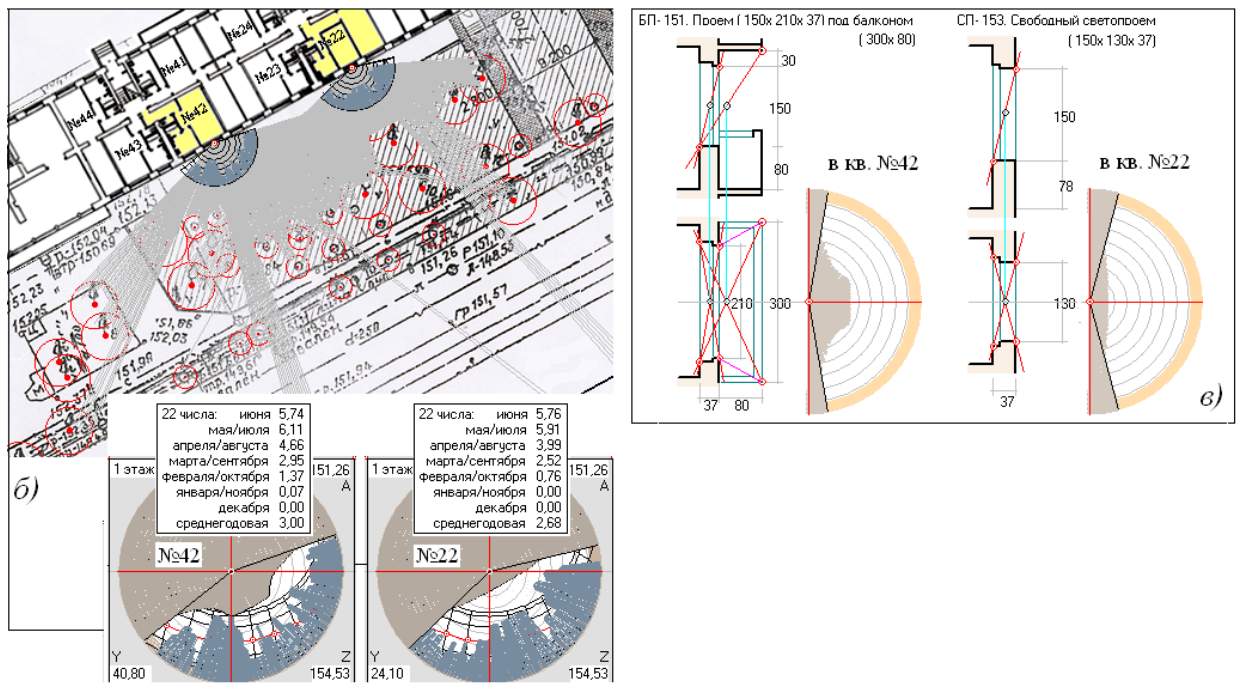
Годовой режим инсоляции в жилых комнатах квартир № 42 и № 22 и вышележащих квартир в существующем доме в г. Н. Новгороде после вырубке деревьев (б) и расчетные схемы светопроемов с телесными углами ограничения инсоляции подоконника элементами стены и балкона (в)
